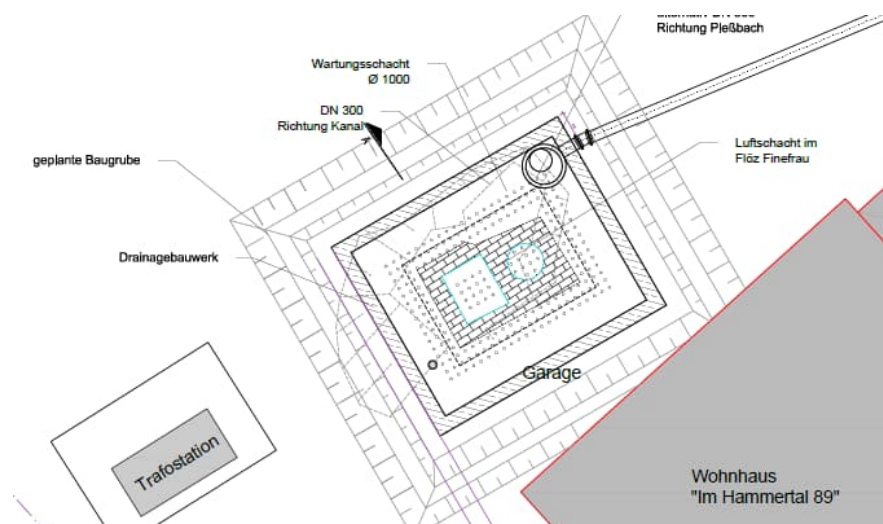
Geplante Lage Sicherungs- und Drainagebauwerk nach Planungsanpassung mit Baugrubenplanung und aufgemessenem Schachtkörper
